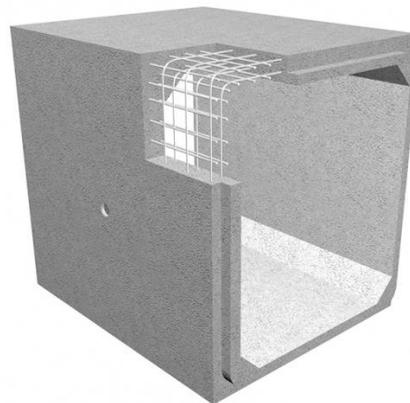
Ejemplo de pieza prefabricada en hormigón armado con detalle de la armadura.
